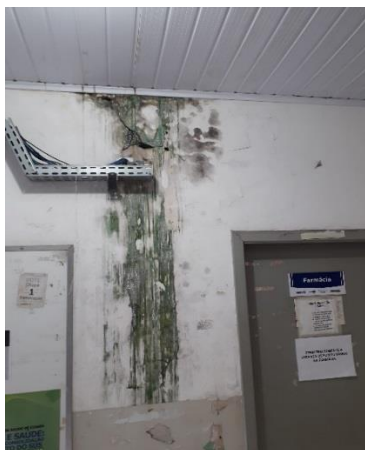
Infiltração generalizada – Centro de Saúde Planalto
